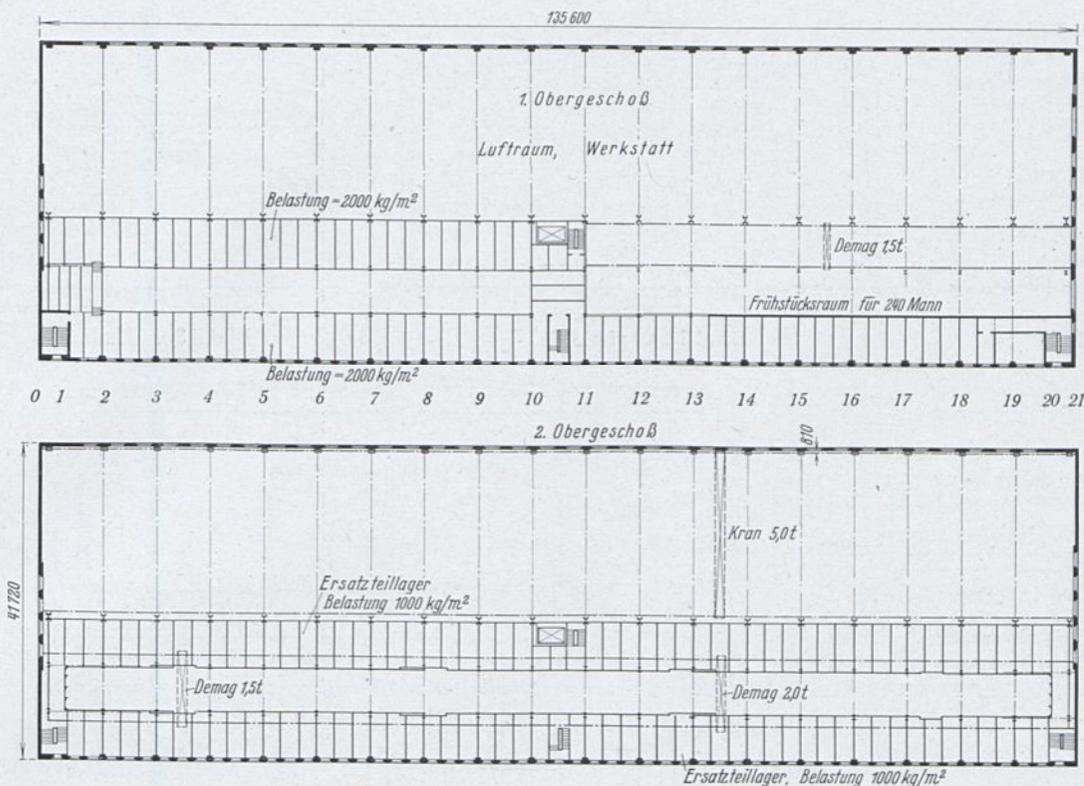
Grundrisse des 1. u. 2. Obergeschosses Halle 7.
